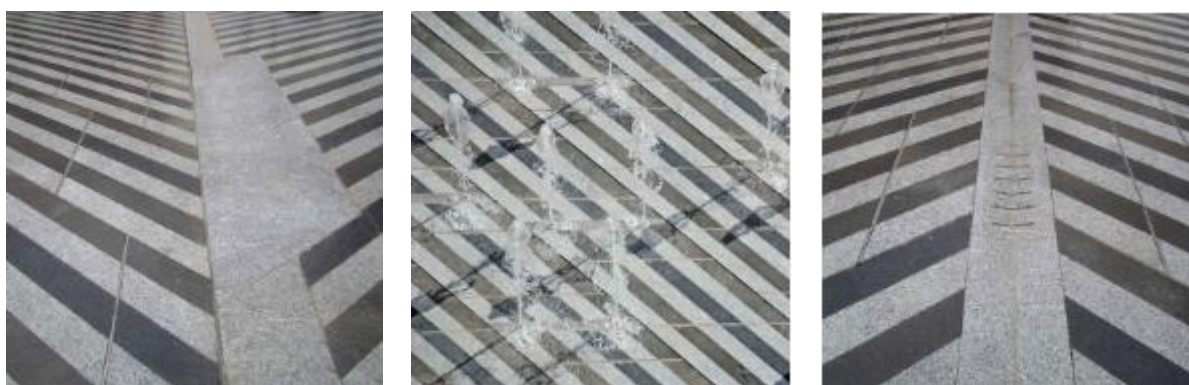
Pavimento – chorros – rejillas de desagüe de la fuente
